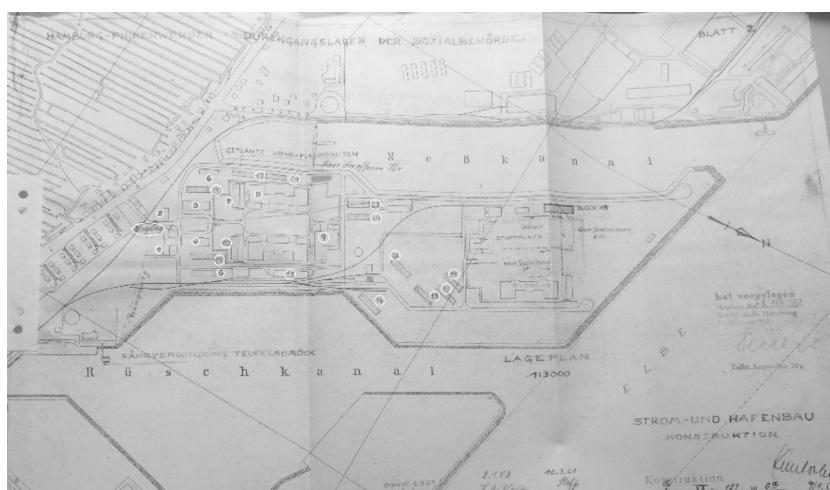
zeigt einen Lageplan des Lagers Finkenwerder im Hamburger Hafen. Der Plan zeigt das abgeschlossene Gebiet des Lagers auf der Rüschhalbinsel, das vor allem in den 1950er Jahren für Geflüchtete aus Ungarn genutzt wurde. Nummerierte Wohnbaracken, Gemeinschaftsräume, Verwaltungsbaracken, und Räume für Hygiene, Essensversorgung, Unterricht oder Kinos strukturieren physisch und sozial den Raum: es werden Grenzen von Mobilität und Sozialität gesetzt, die Machtverhältnisse zwischen Bewohner*innen und Verwaltungspersonal prägen. Das Lager ist abgeschlossen von seiner Umgebung, es gibt nur einen Eingang, und Grenzen zwischen gemeinschaftlicher Öffentlichkeit und Privatsphäre verschwimmen im kontrolliert geplanten Barackendorf. Somit entstehen in Architektur soziomaterielle Umgebungen für Kommunikation: wo sie möglich war, wo nicht, und wie reguliert.
